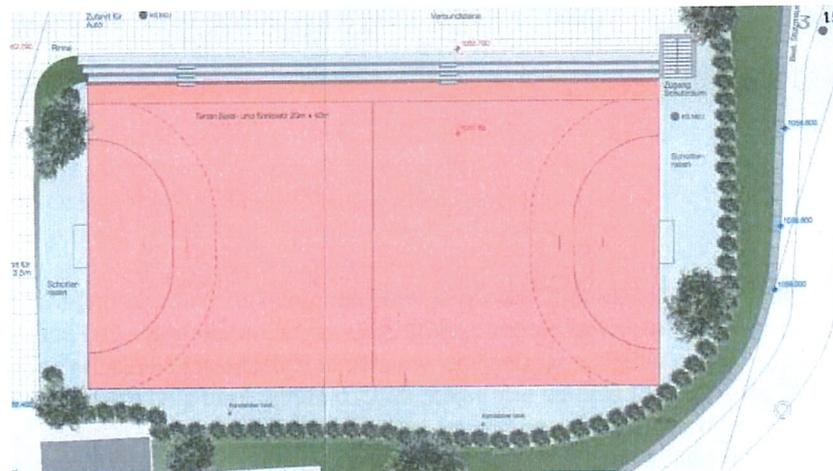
Plan Sportplatz beim Schulhaus (Unterlagen Baubewilligung).
